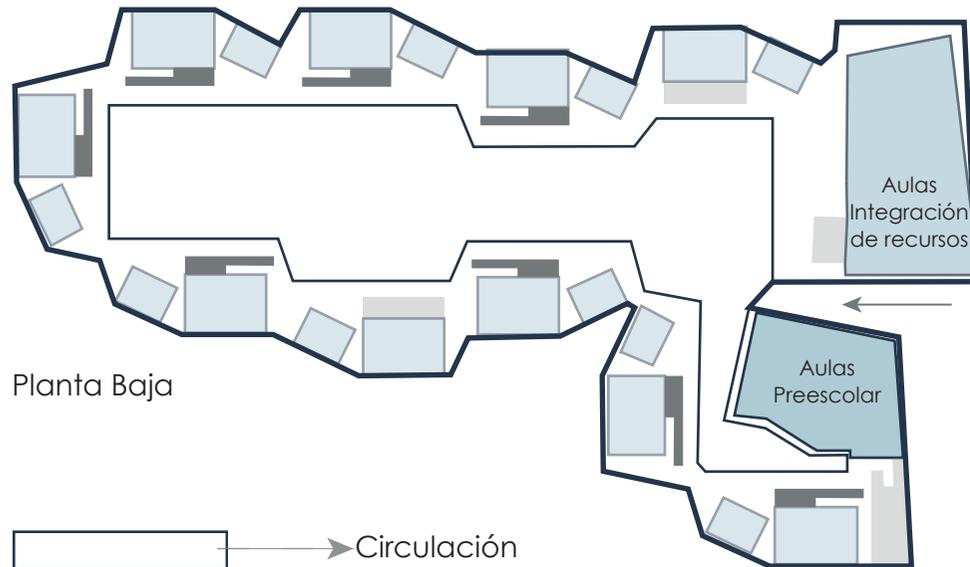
Planta Estructural - Colegio Gerardo Molina
